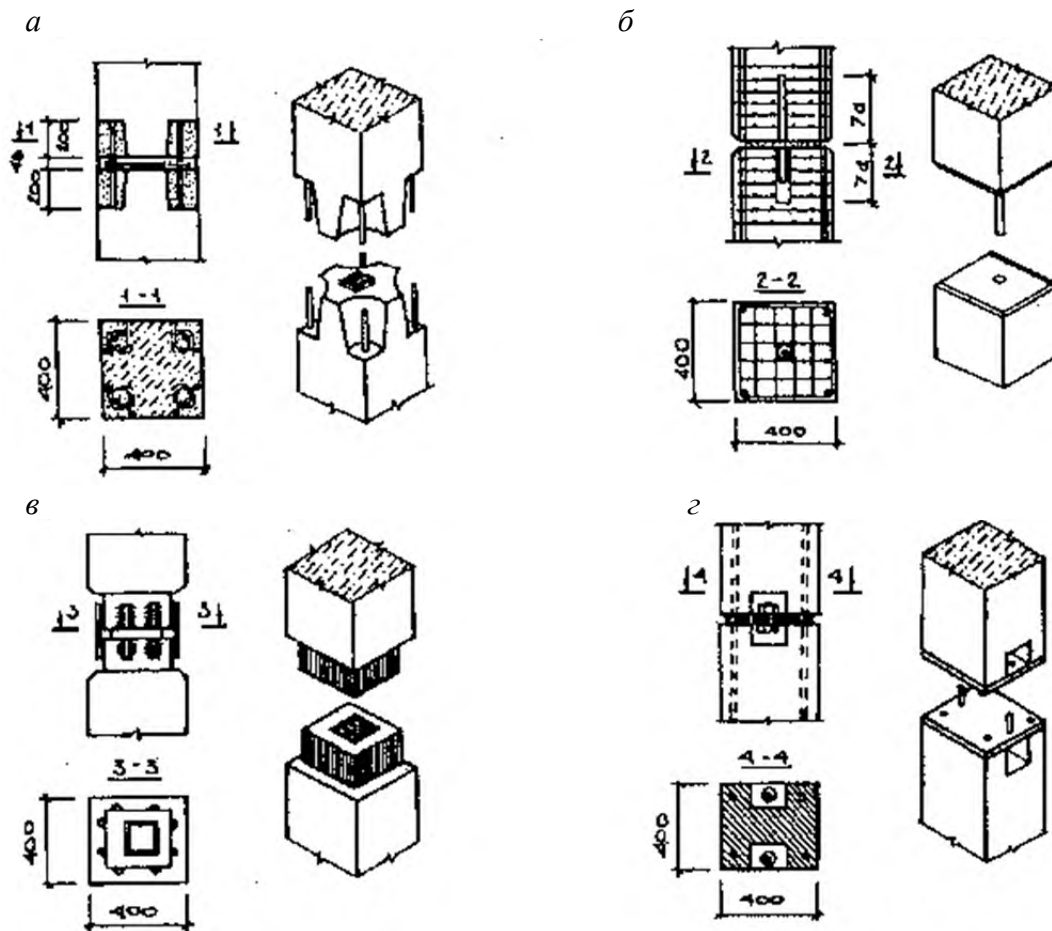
Варианты стыков сборных железобетонных колонн с гибкой арматурой:
